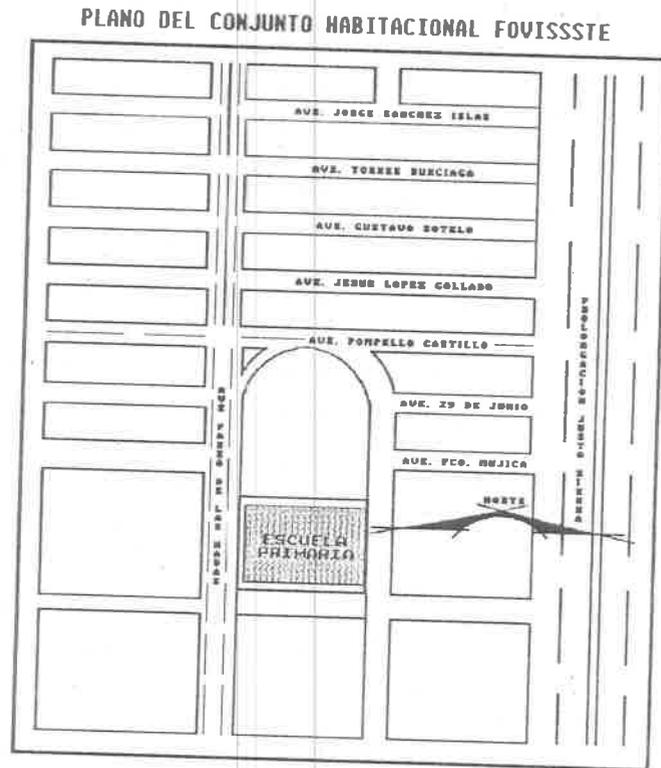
Plano del Fraccionamiento FOVISSSTE
